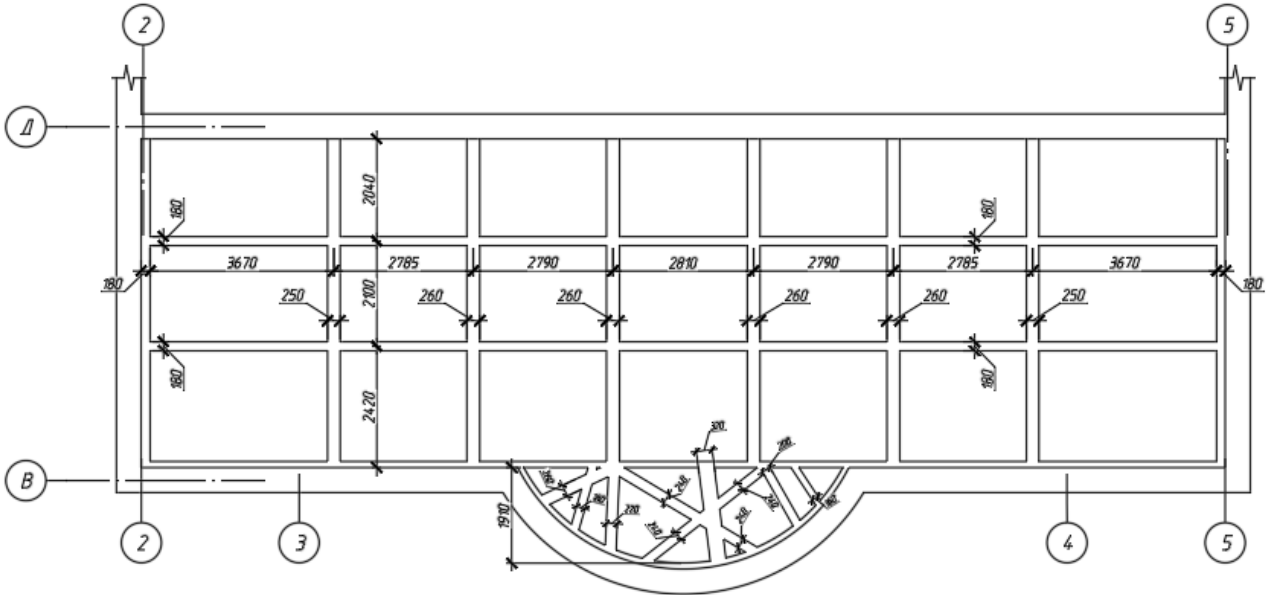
Схема залізобетонної монолітно-ребристої плити перекриття в осях 2-5/В-Д
